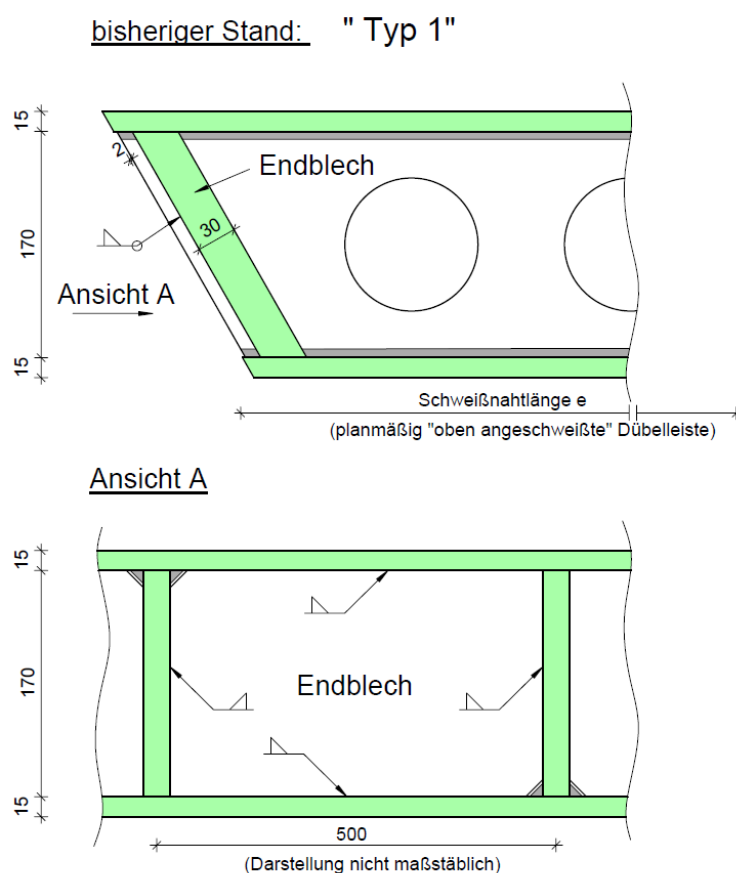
Skizze der Ausführungsvariante Typ 1 (zusätzliche Schweißnähte in der Ansicht nicht dargestellt) aus [11]
